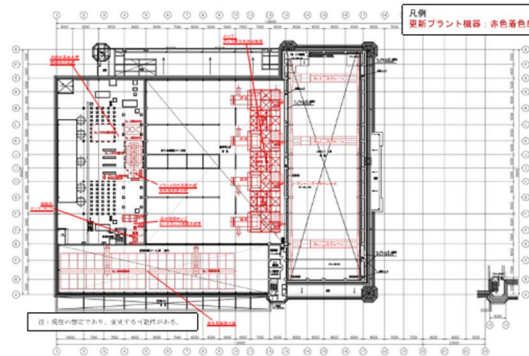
(8) 設備機器の更新箇所 (クレーン階平面図)
